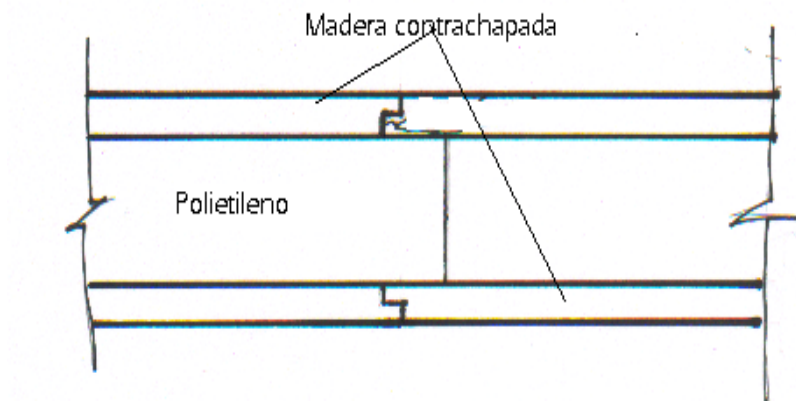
(a). Panel tipo sándwich, usado como cubierta para estructuras de techumbre.
